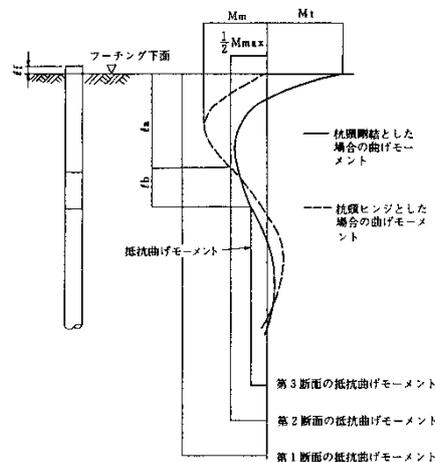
PHC杭の断面変化の設計位置 (杭基礎設計便覧, 図-III.2.47, H19.1, 日本道路協会)
